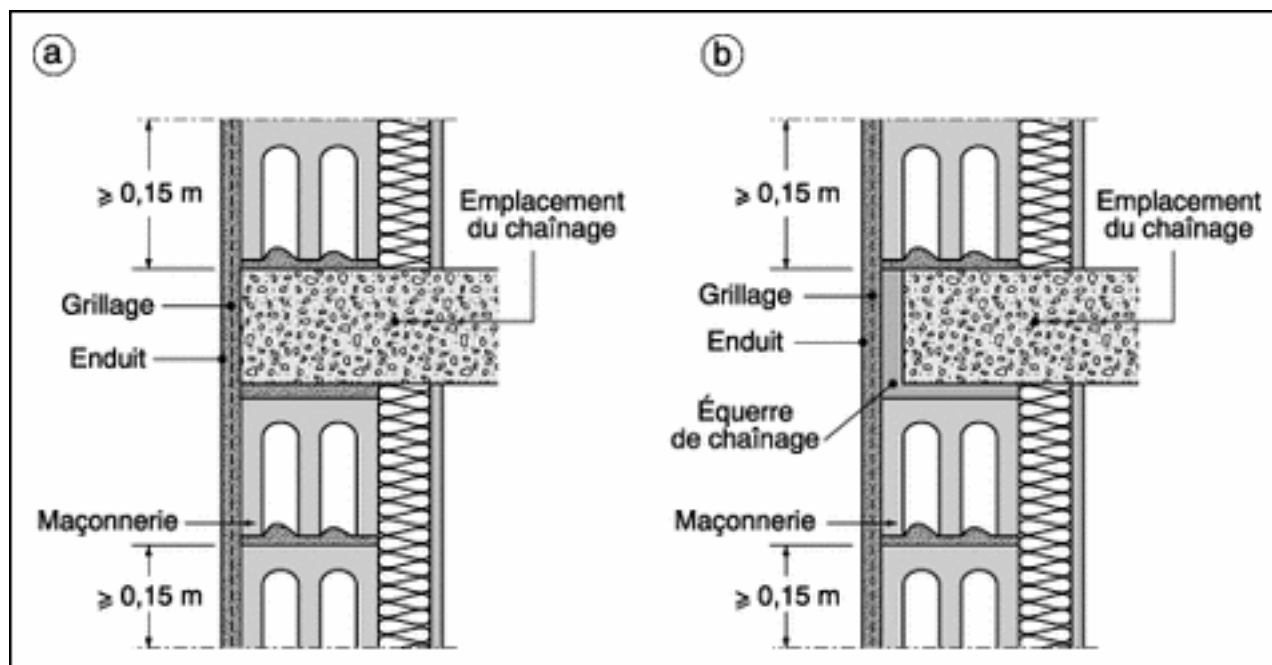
Exemple de jonction en façade, sans désolidarisation, dans le cas d'une maçonnerie enduite
